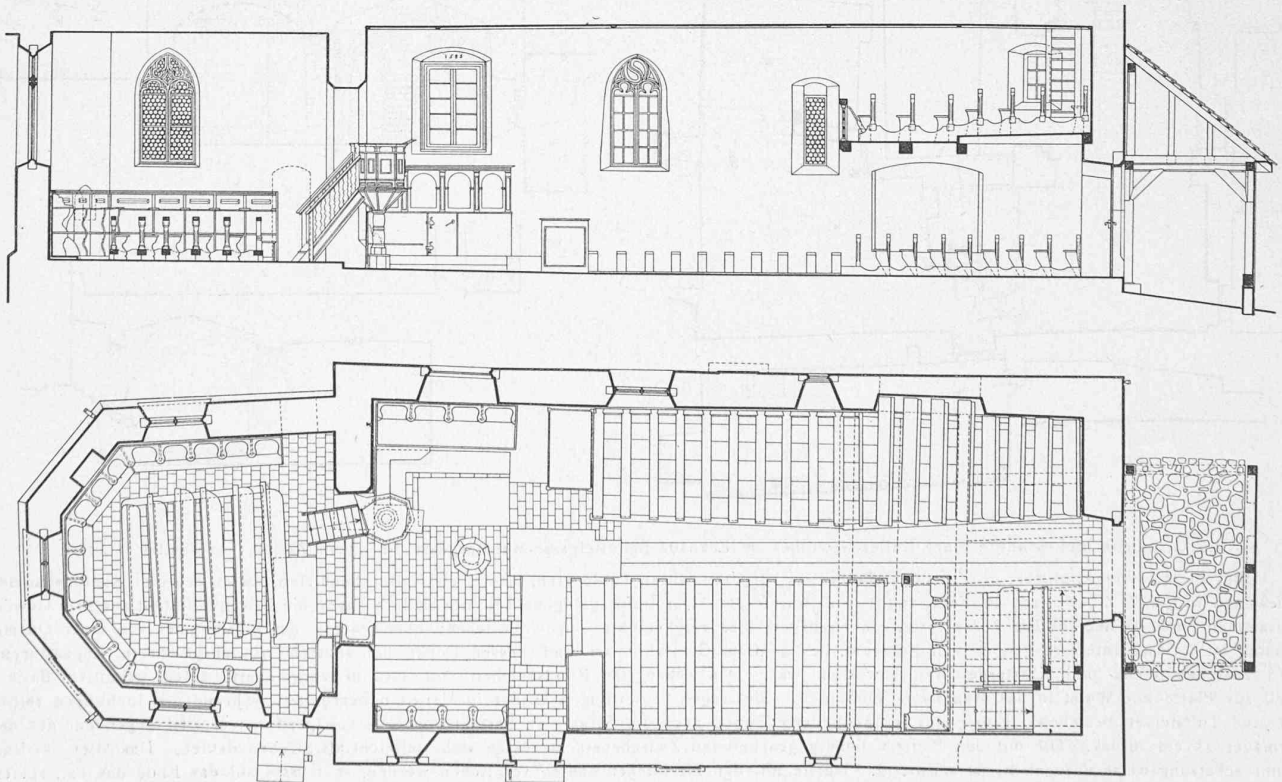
und 5. Grundriss und Längsschnitt mit Südwand der Kapelle Hausen bei Ossingen.
